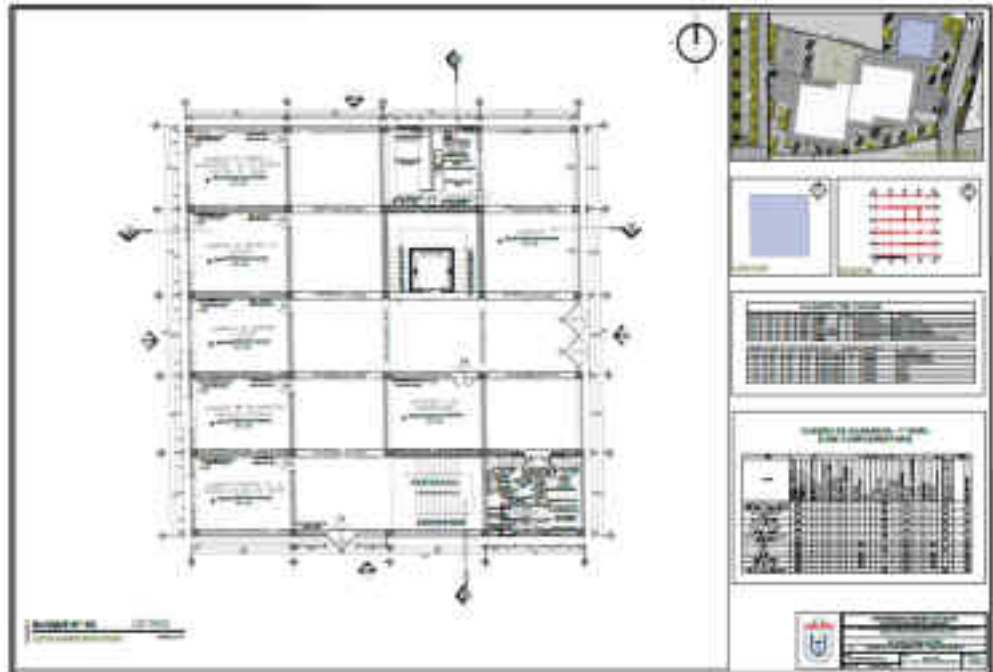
Planimetría del primer nivel – bloque N° 03
